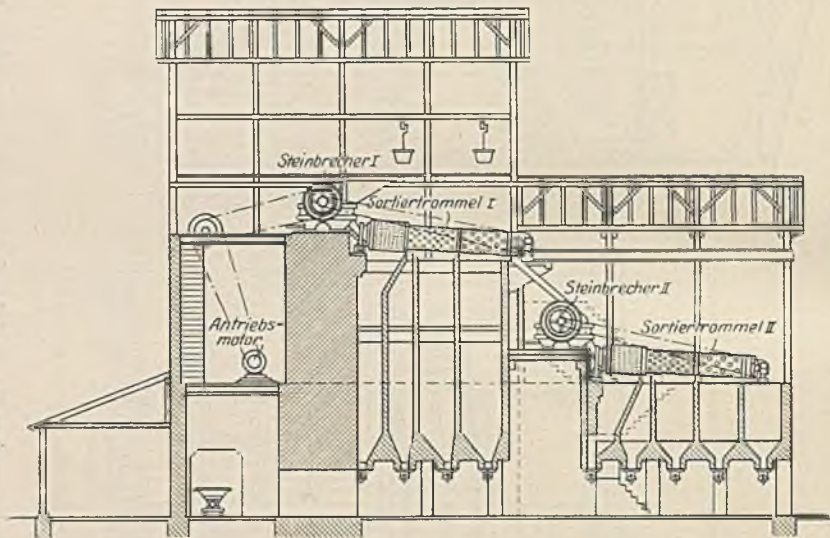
Schotterbereitungsanlage der Krupp-Grusonwerke. (Hinter dem 1. Steinbrecher mit Sortiertrommel ist noch ein 2. Steinbrecher mit Sortiertrommel angeschlossen.)
